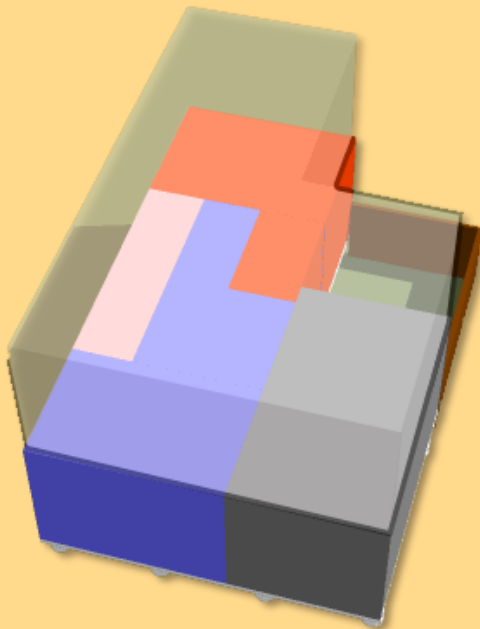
Esquema de implantações mostrando acessos, tipologias, insolação, ventilação e eixo estruturador Fonte: Autorial.
